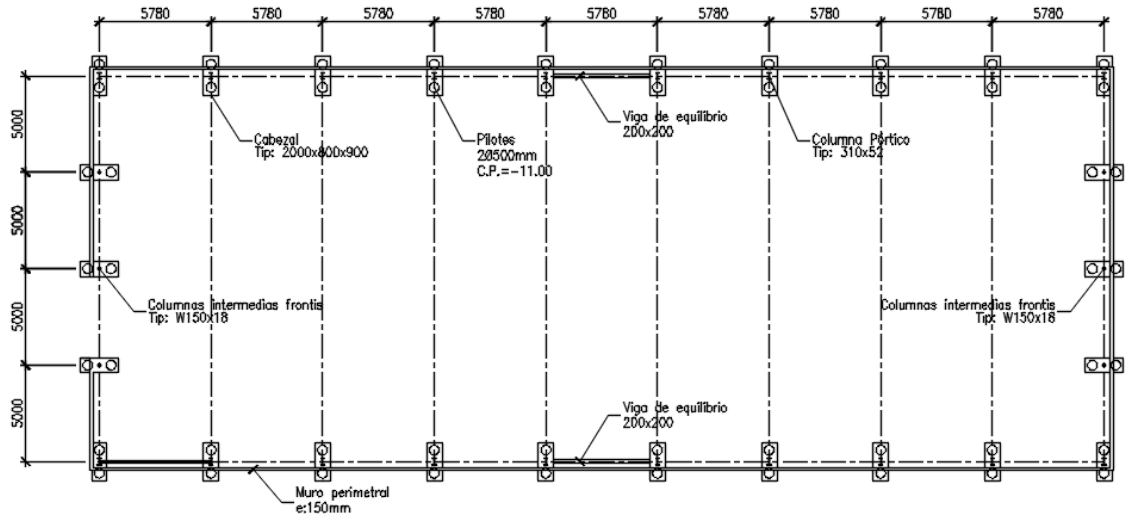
Planta de fundaciones – galpón de reciclaje.
